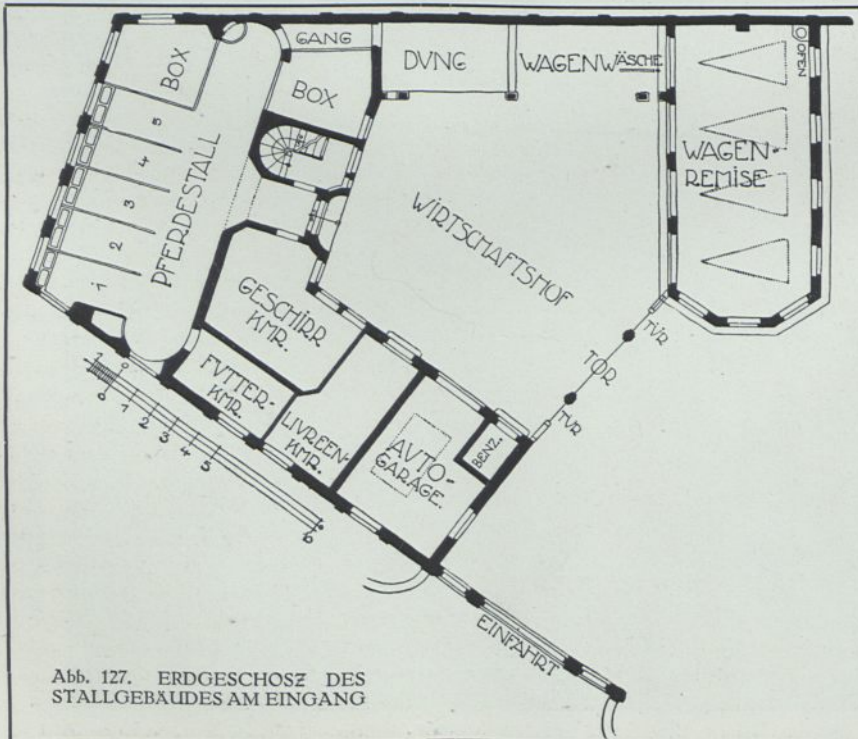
ERDGESCHOSZ DES STALLGEBÄUDES AM EINGANG
